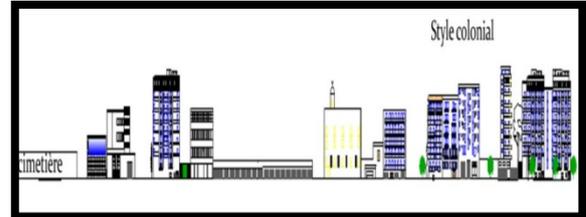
Façade sur le boulevard Med belouizded (sud)
